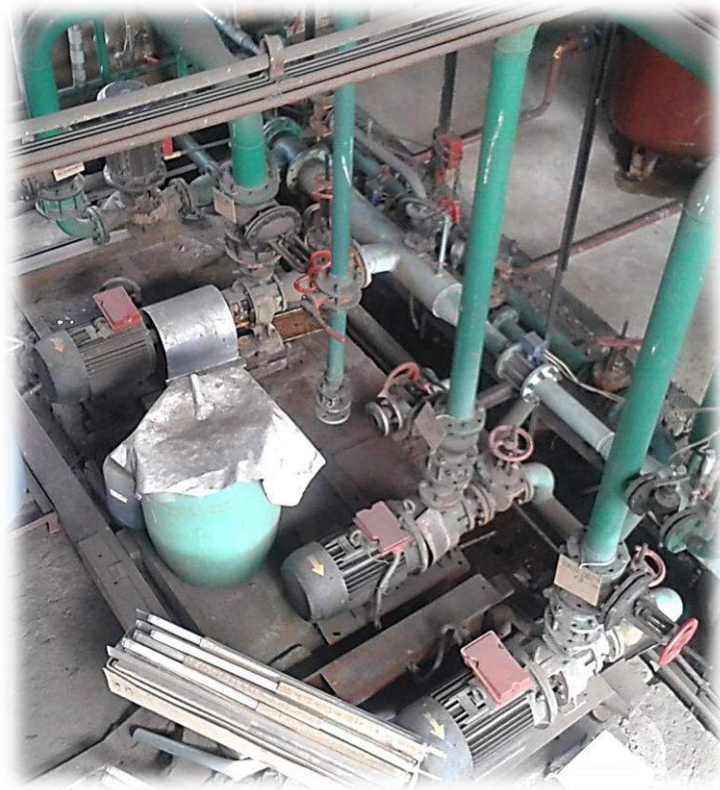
Насосное оборудование котельной.
